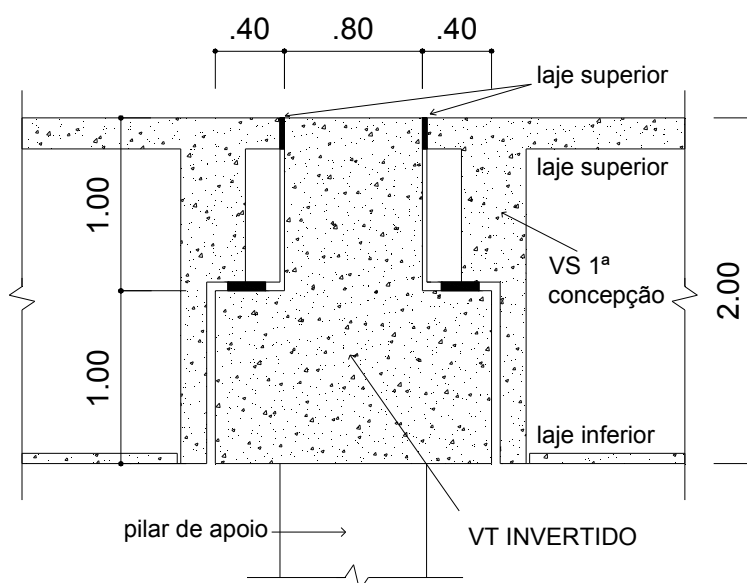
Viga VS 1ª concepção – seção transversal da viga “T” invertido (Relatório de Assessoria UnB – 1997, com modificações)
